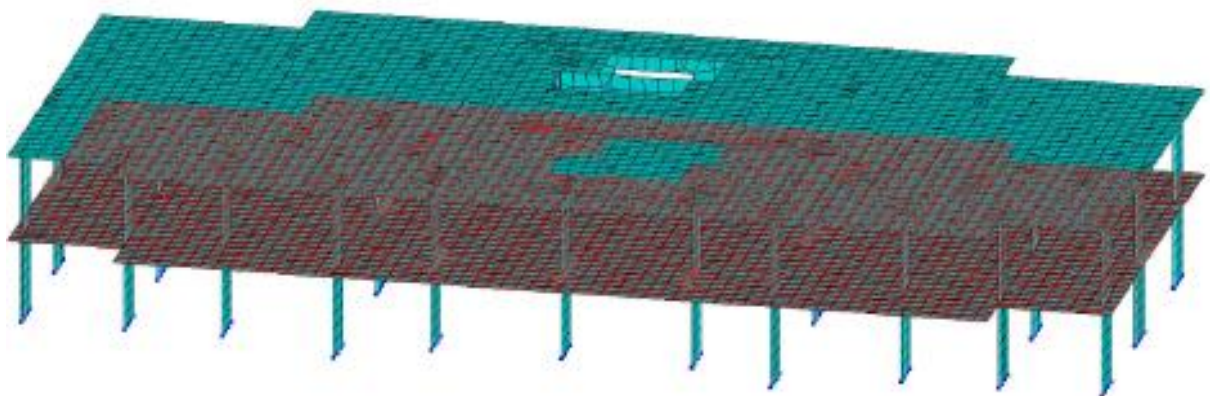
Досліджуваний фрагмент перекриття типового поверху
